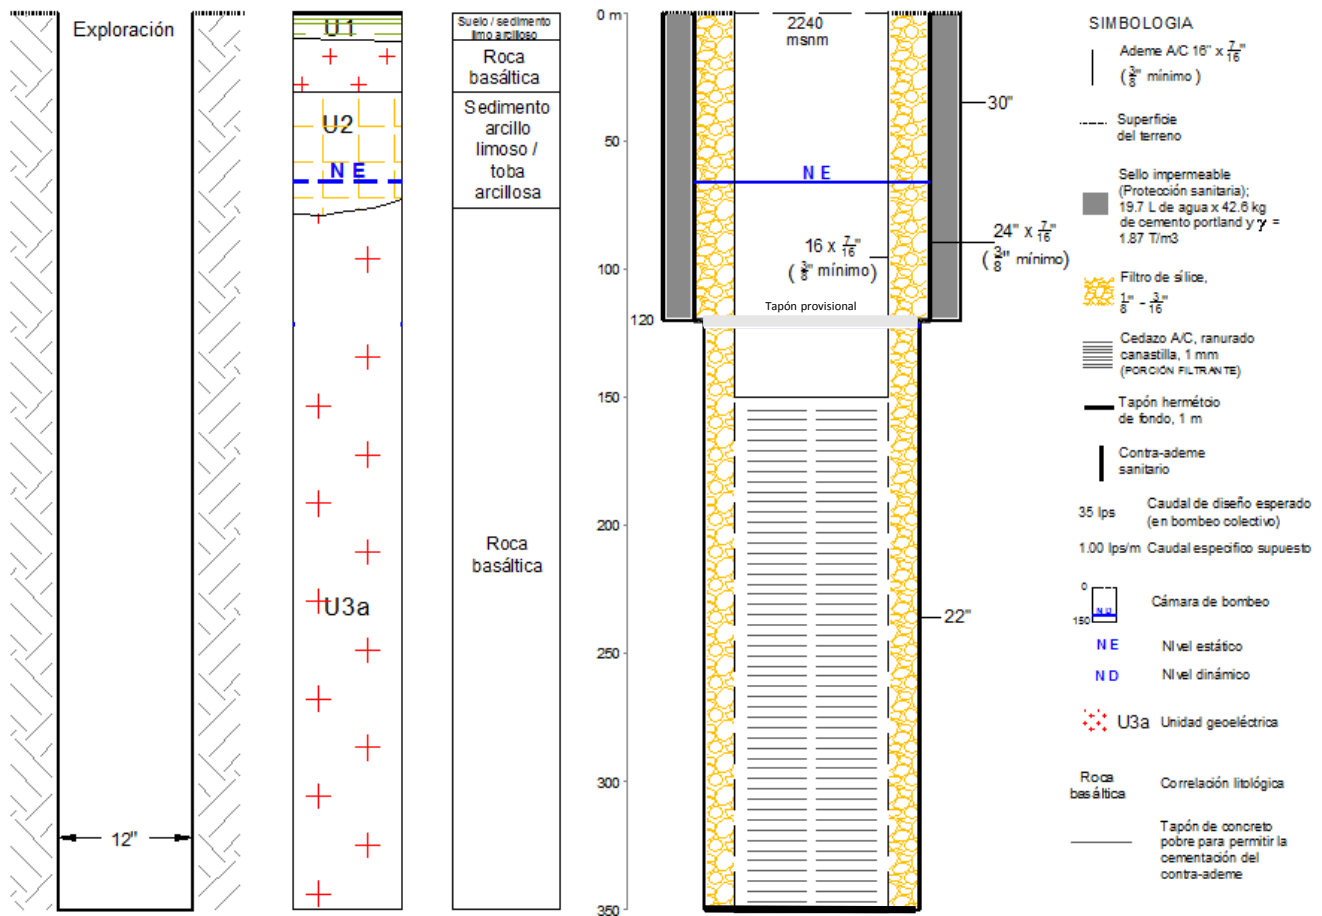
Proyecto de Pozo Tipo 1
